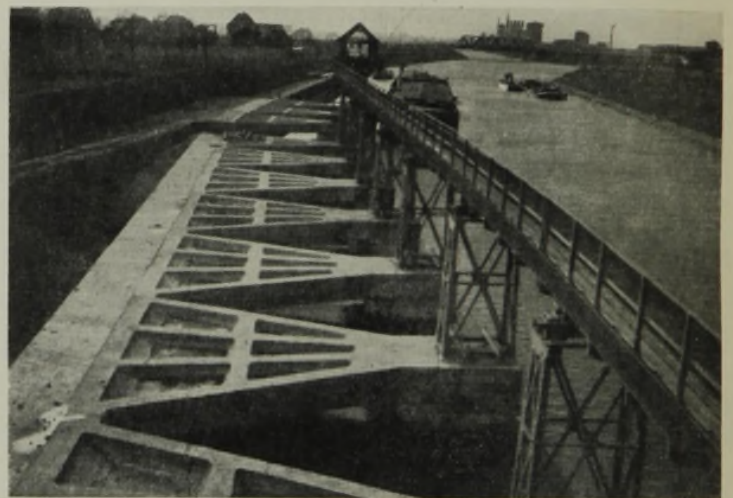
Eisenbetonstreben zur Abstützung der aufgehöhten Betonpfeiler des unteren Leitwerks der gesunkenen Schleuse IV.
